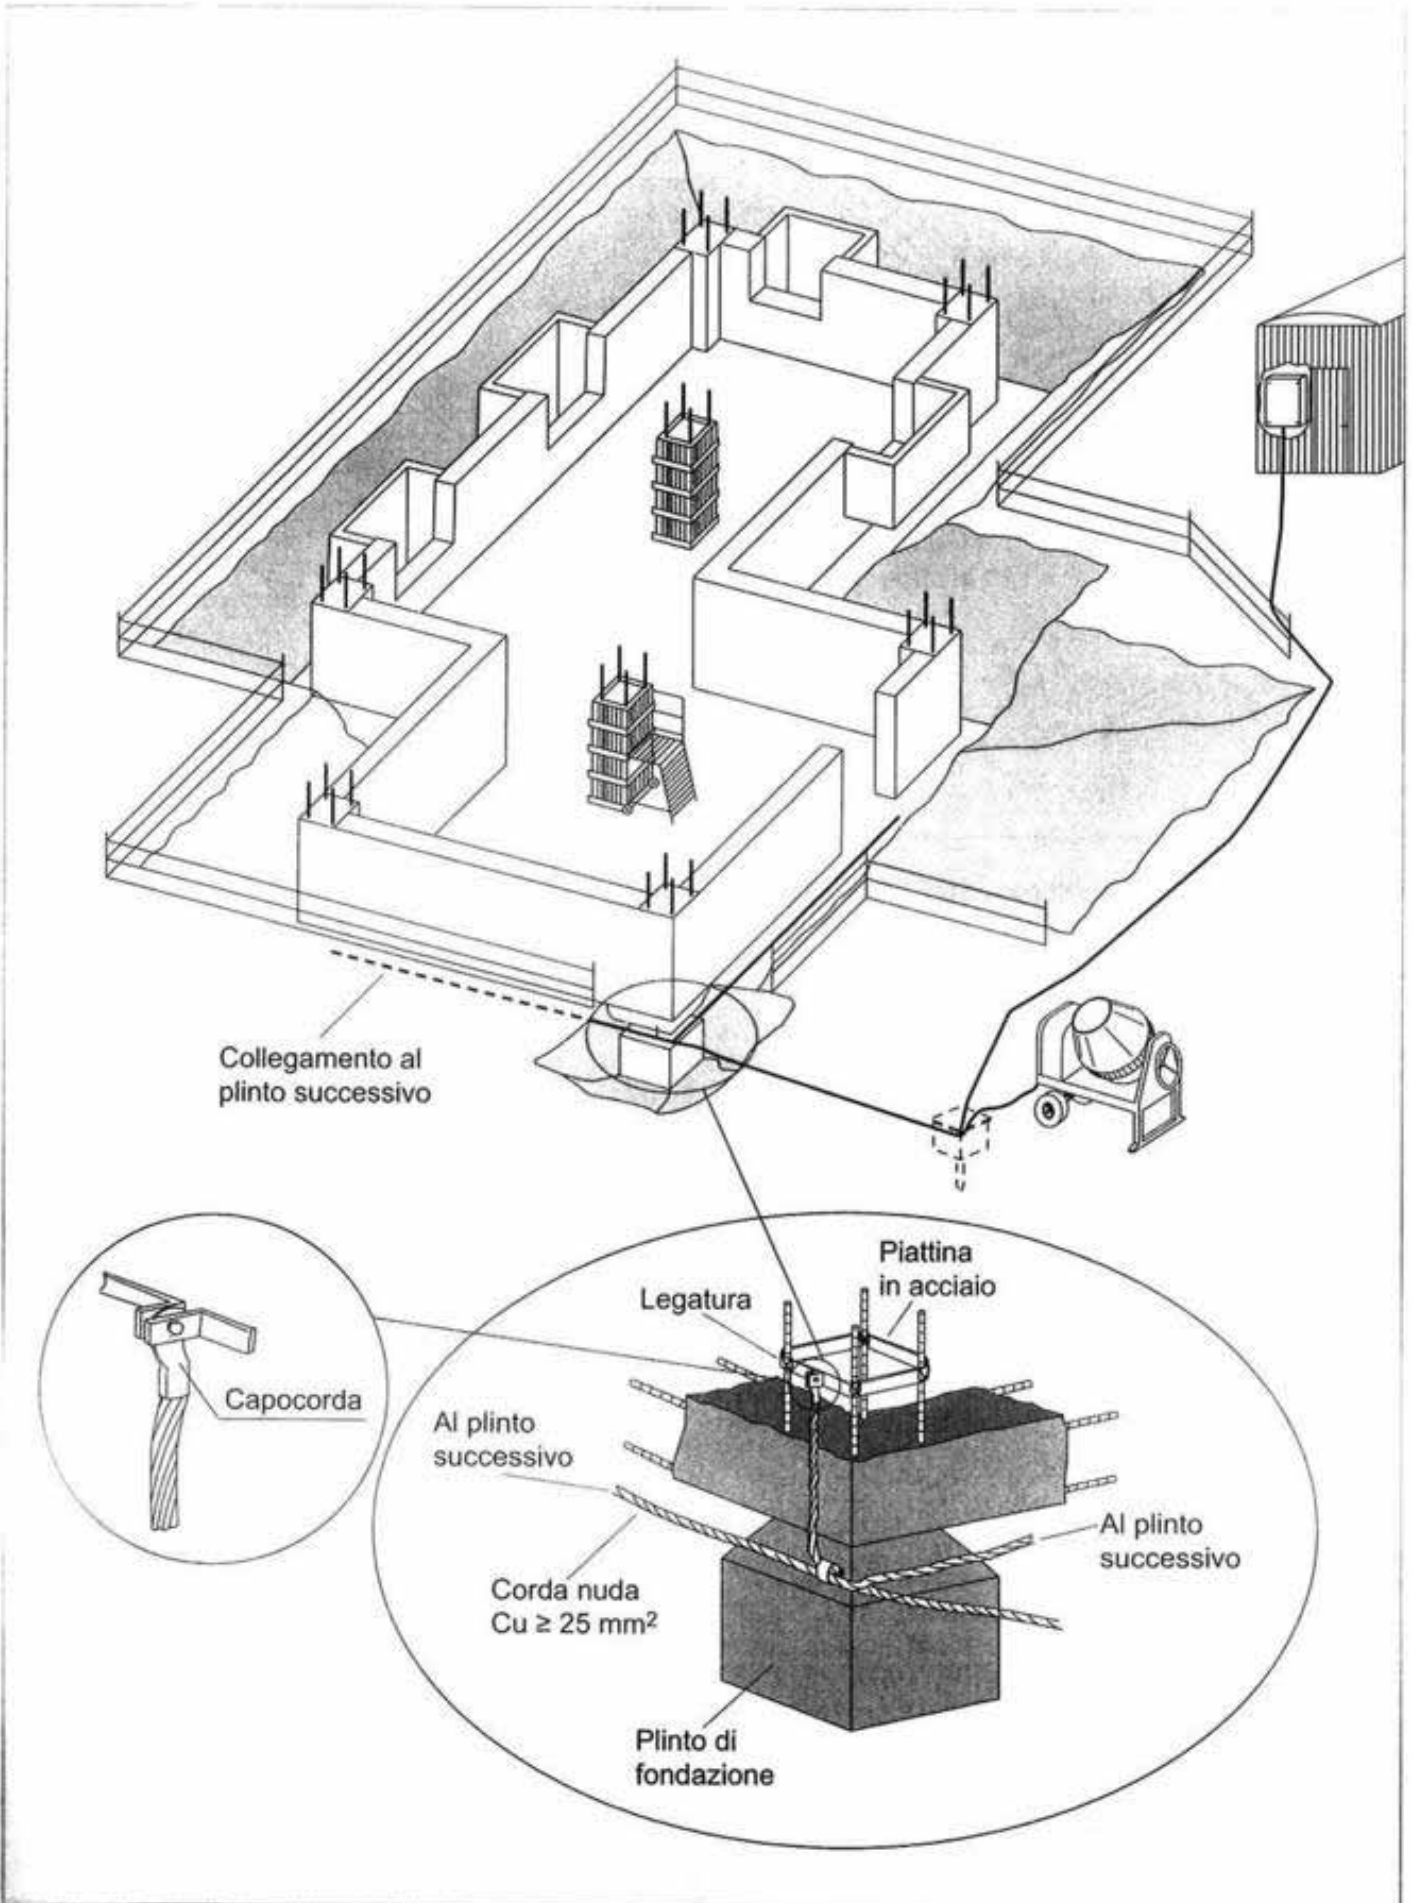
Esempio di impianto di terra di fondazione.
